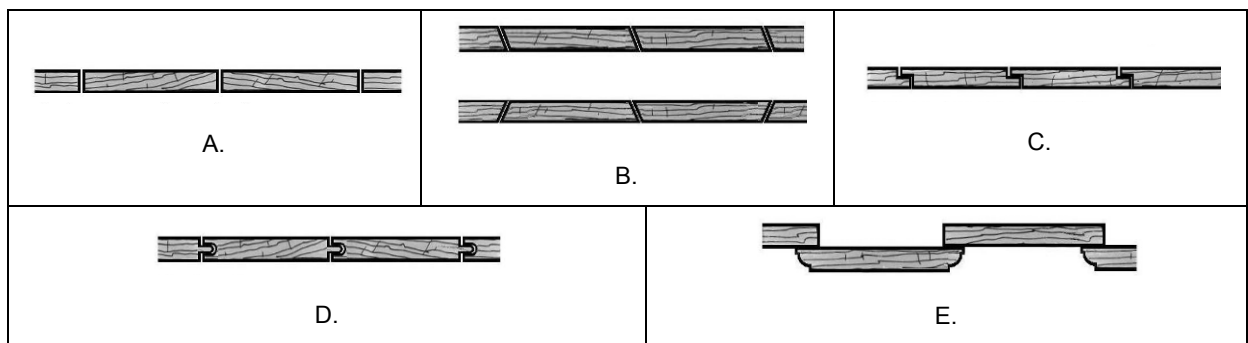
Construção do forro tendo em conta o tipo de ligação entre as tábuas [9].
